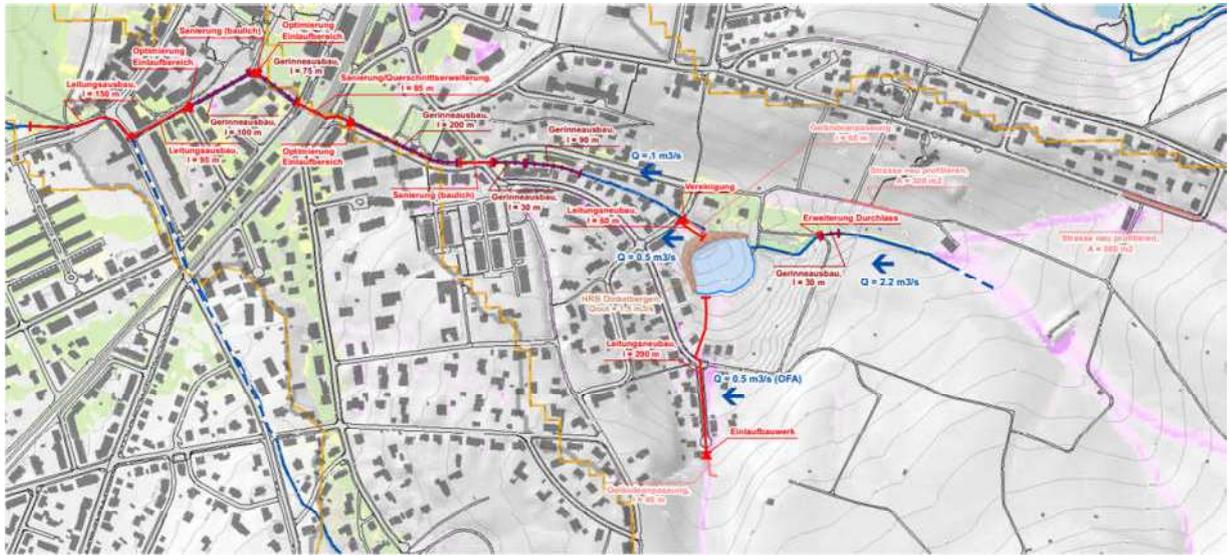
Ausschnitt aus dem Situationsplan Variante 3
